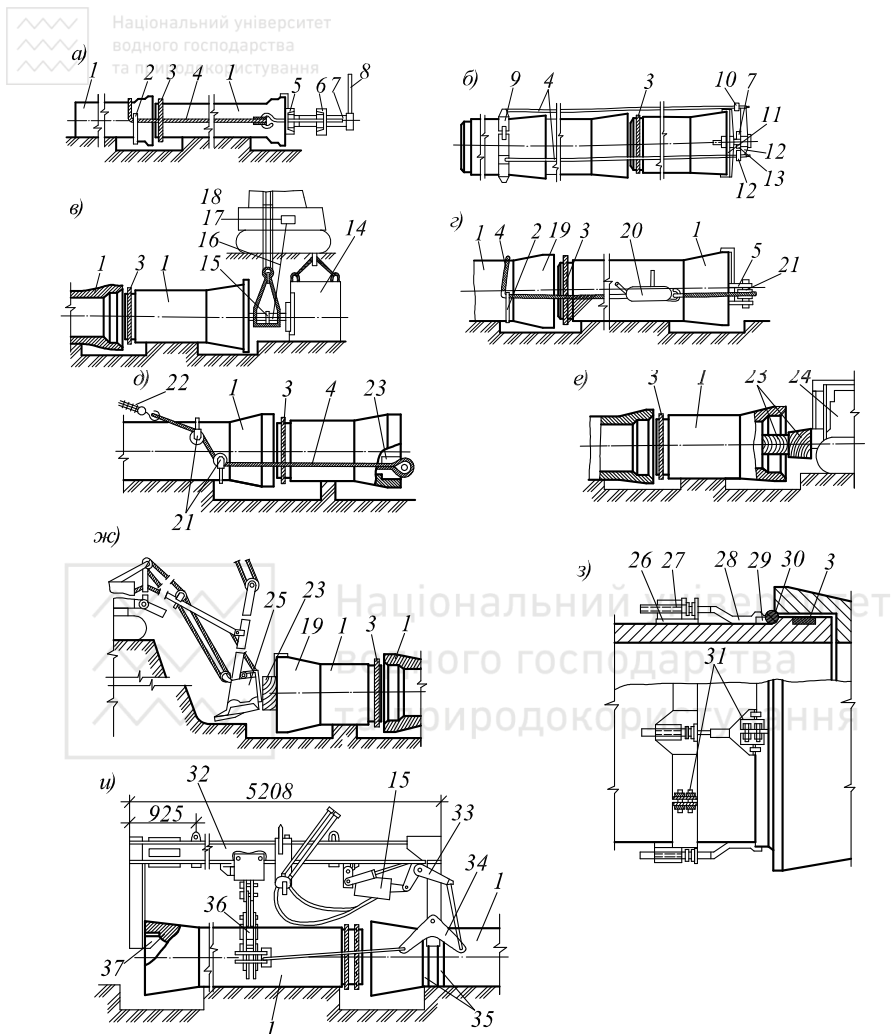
Способи монтажу розтрубних напірних залізобетонних труб і застосовувані для цього пристосування:
